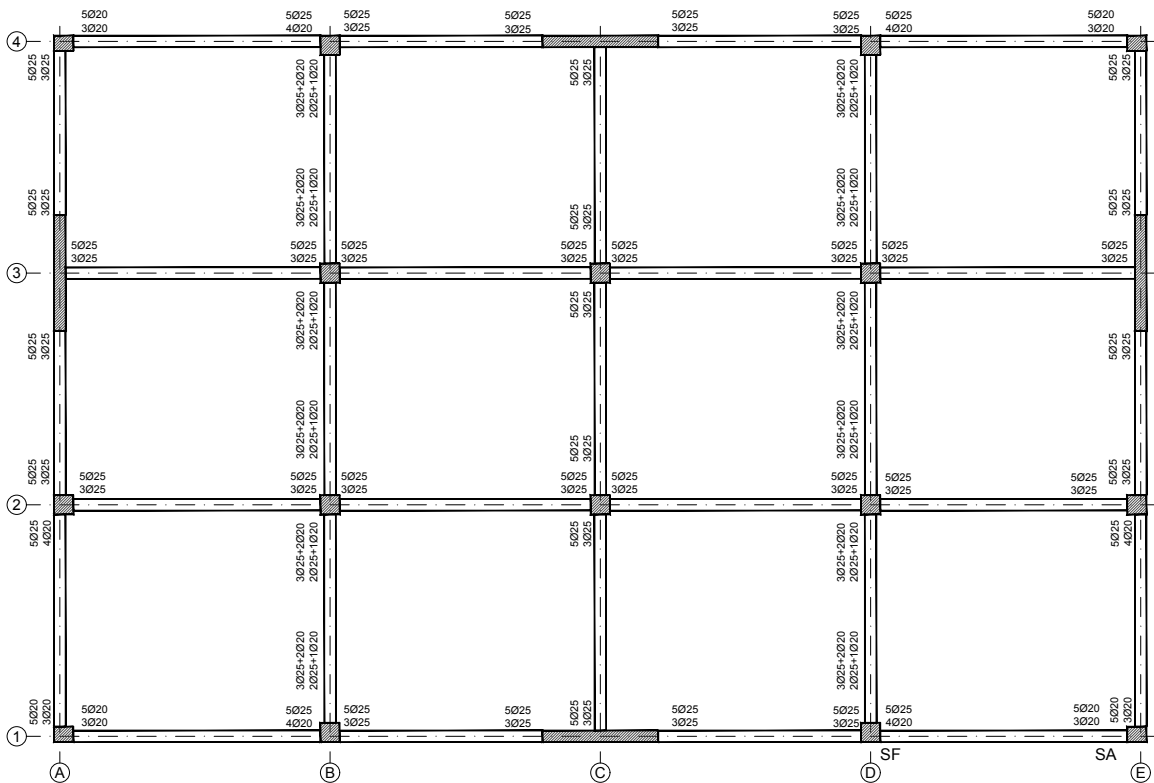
Armadura longitudinal dos apoios – Pisos 2 a 8.
